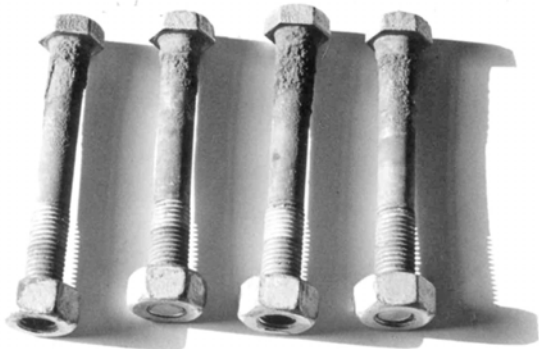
Узел крепления наклонных подвесок к верхнему поясу висячей фермы. Коррозия болтов вследствие попадания воды в пространство между соединительными деталями узла
